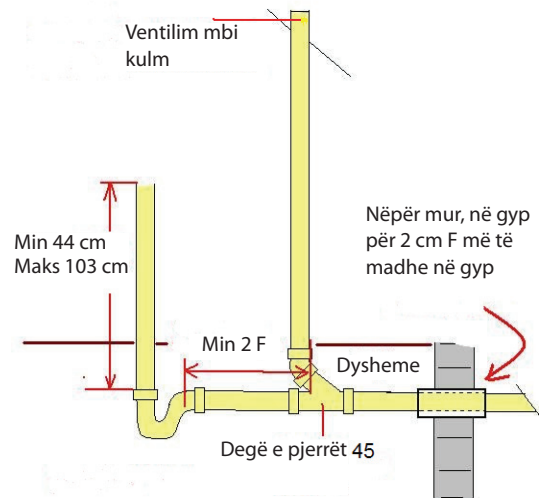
Skema e vendosjes të gypave të kanalizimit në shtëpi
